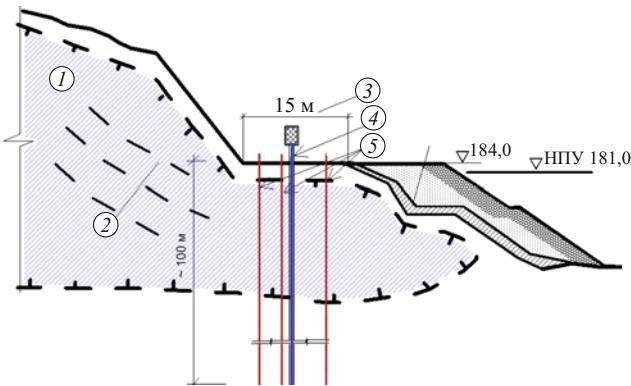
Конструктивная схема опытного полигона на строительной площадке Вилюйской ГЭС-3:
